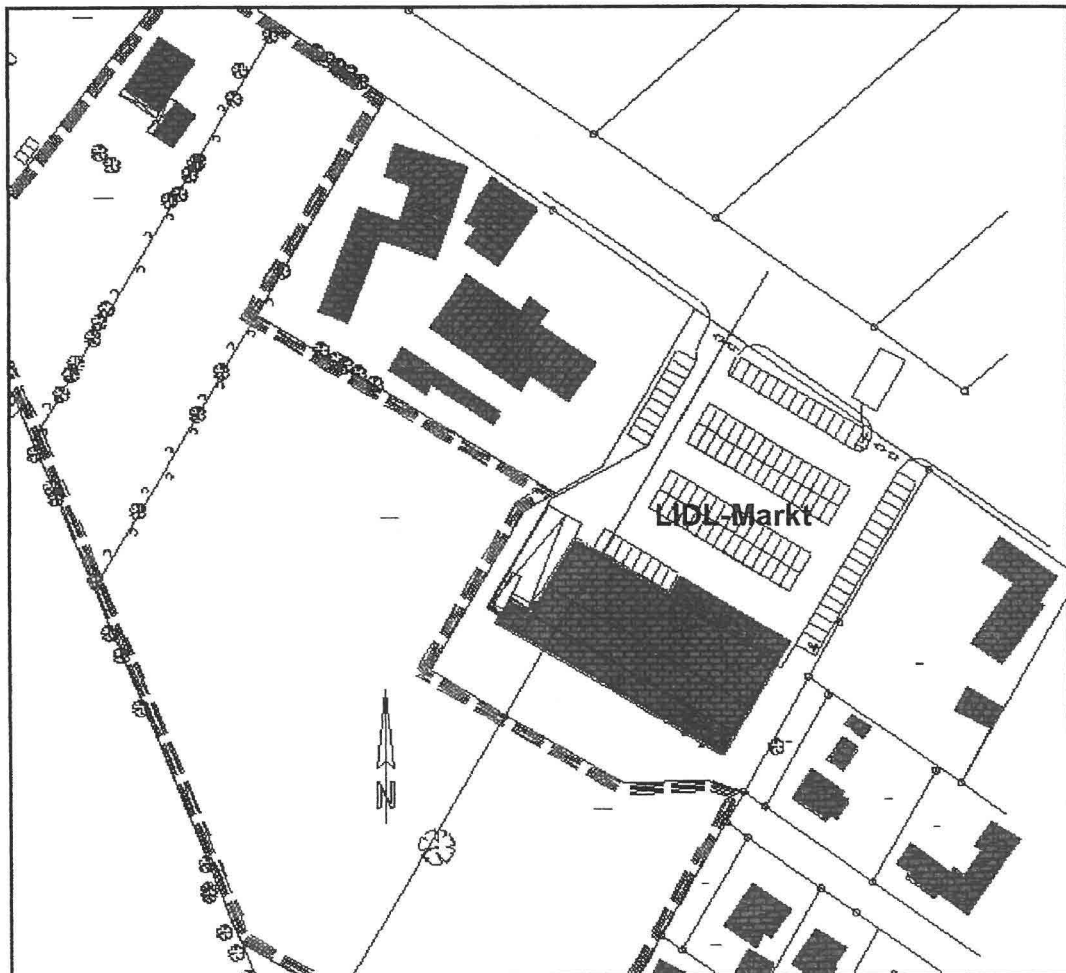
Lageplan mit geplantem Lidl-Markt und Umgebung
